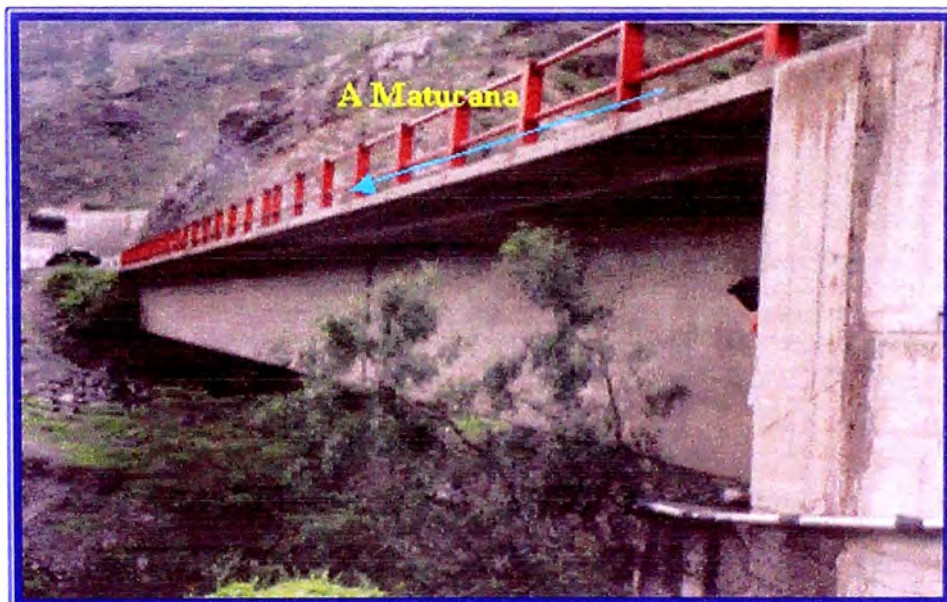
Puente Cascada (Km. 59+180) de longitud 52 m. ,tablero tipo losa y vigas T.
